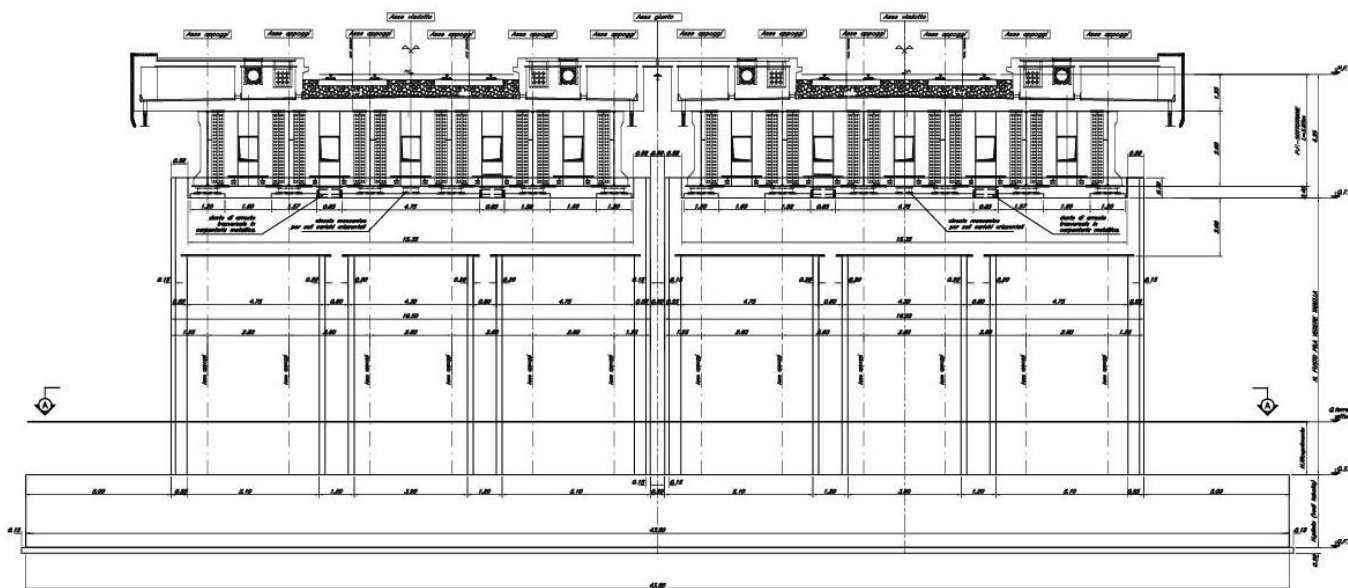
Prospetto Pila P03 - P04 -sezione trasversale
